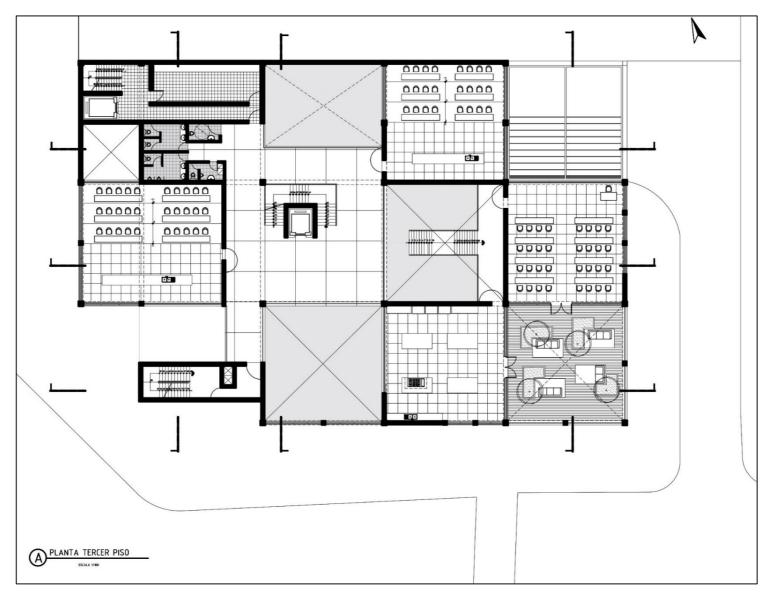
Planta de distribución - Tercer Nivel Fuente: elaboración propia
